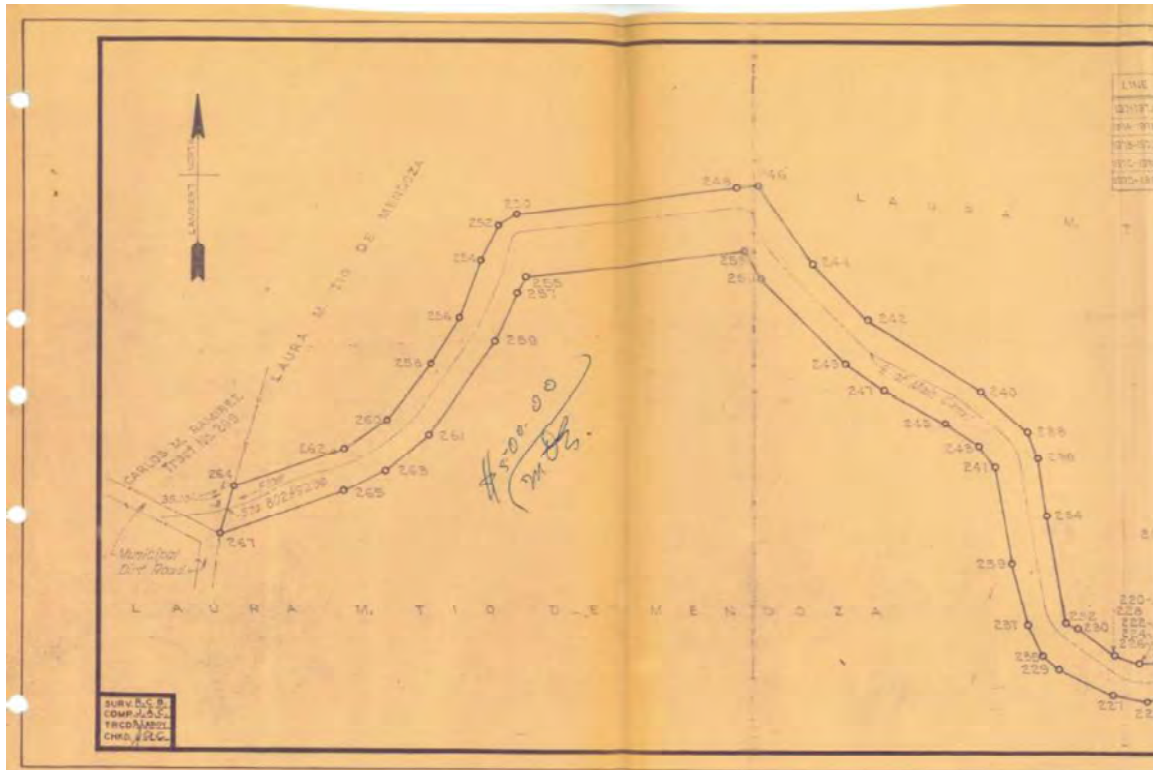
A: Plano Escala: 1"=100' - Recomendado -Nov. 30-1956, Land Track No.268 – Puerto Rico Resources Authority Engineering and Construction División / Southwestern P.R., Project- Laura M. Tió de Mendoza-Track – Area to be Acquired, Bo. Lajas – Lajas, P.R.
